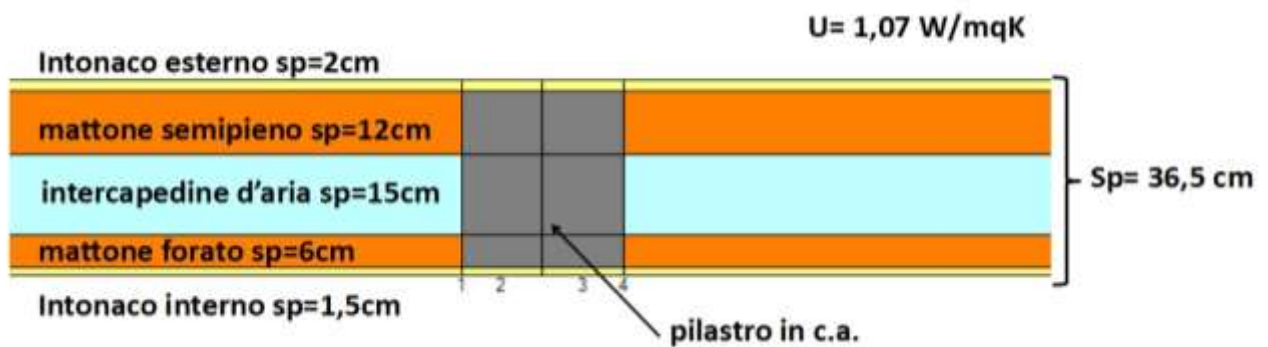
Nodo muro a cassa vuota – pilastro stato non isolato
